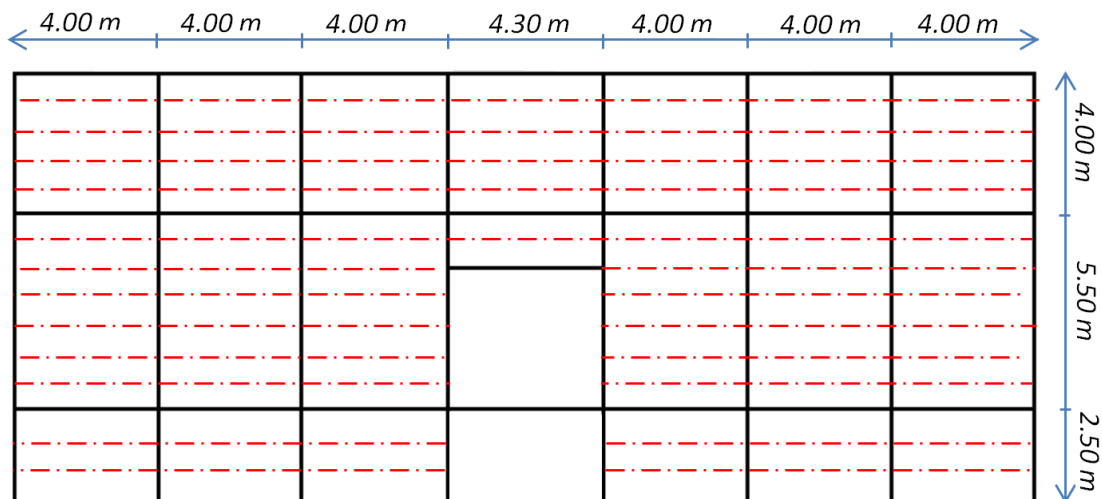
Types des poutrelles pour 4^{eme} étage
